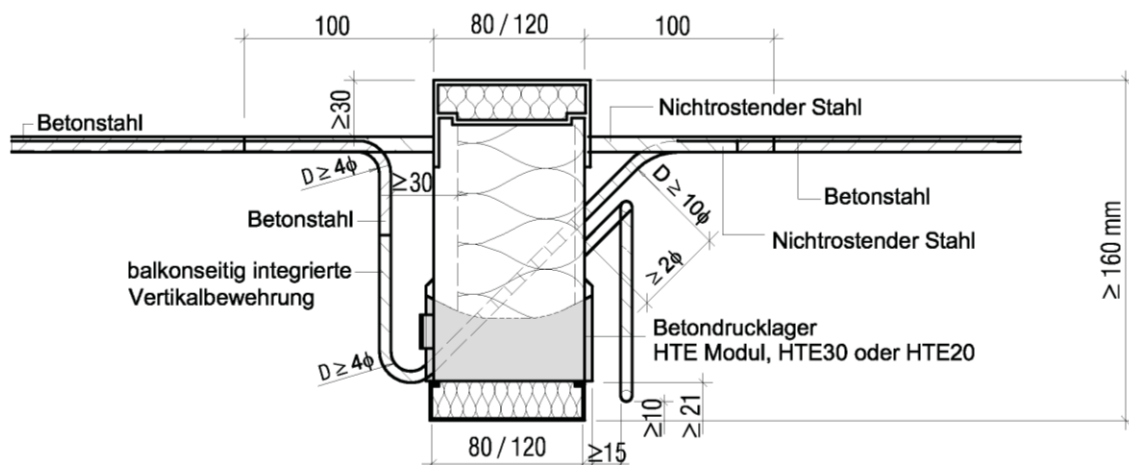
Schöck Isokorb® Typ K mit Sonderbügel.
